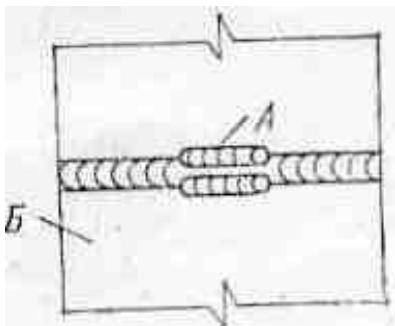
Многократная наварка А на участок сварного соединения и лист стенки Б резервуара в дефектном месте
